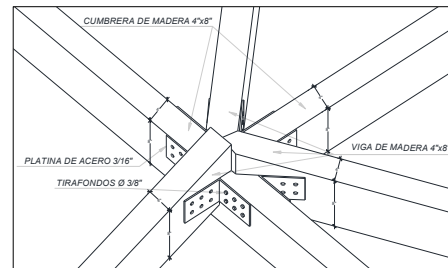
ESTRUCTURA DE MADERA DE VIVIENDAS -DETALLE DE UNIONES
